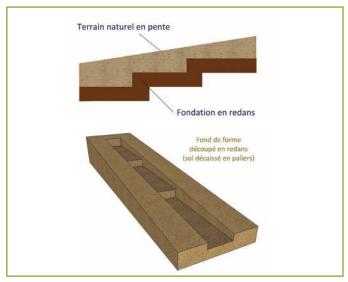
Schéma en coupe de fondations en redans (Dessin de Cédric Houel)
